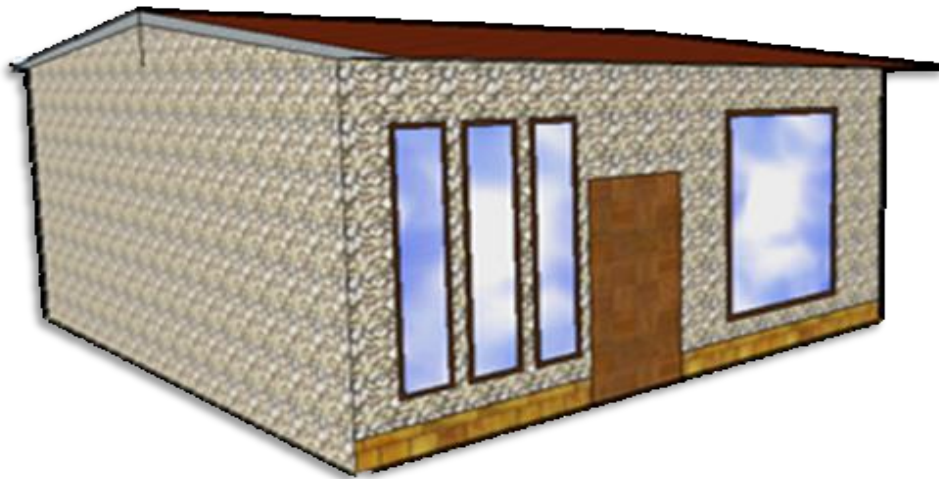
Vivienda con gaviones de electro malla y piedras bolón.
